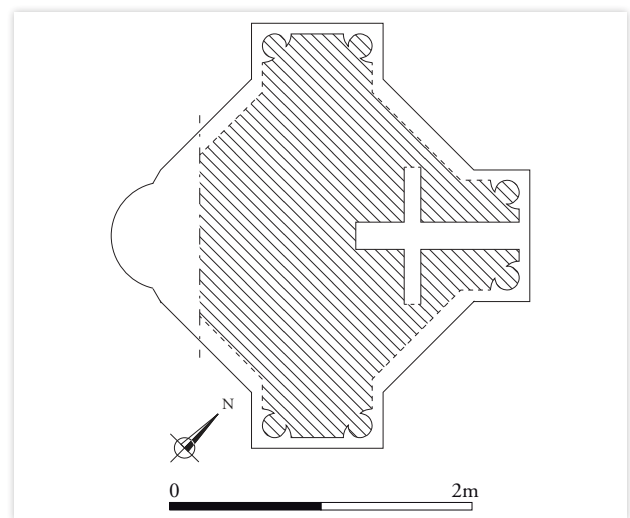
Pilier P 1a, plan des négatifs d'ancrage dans le sommier du doubleau oriental – échelle : 1/50.
